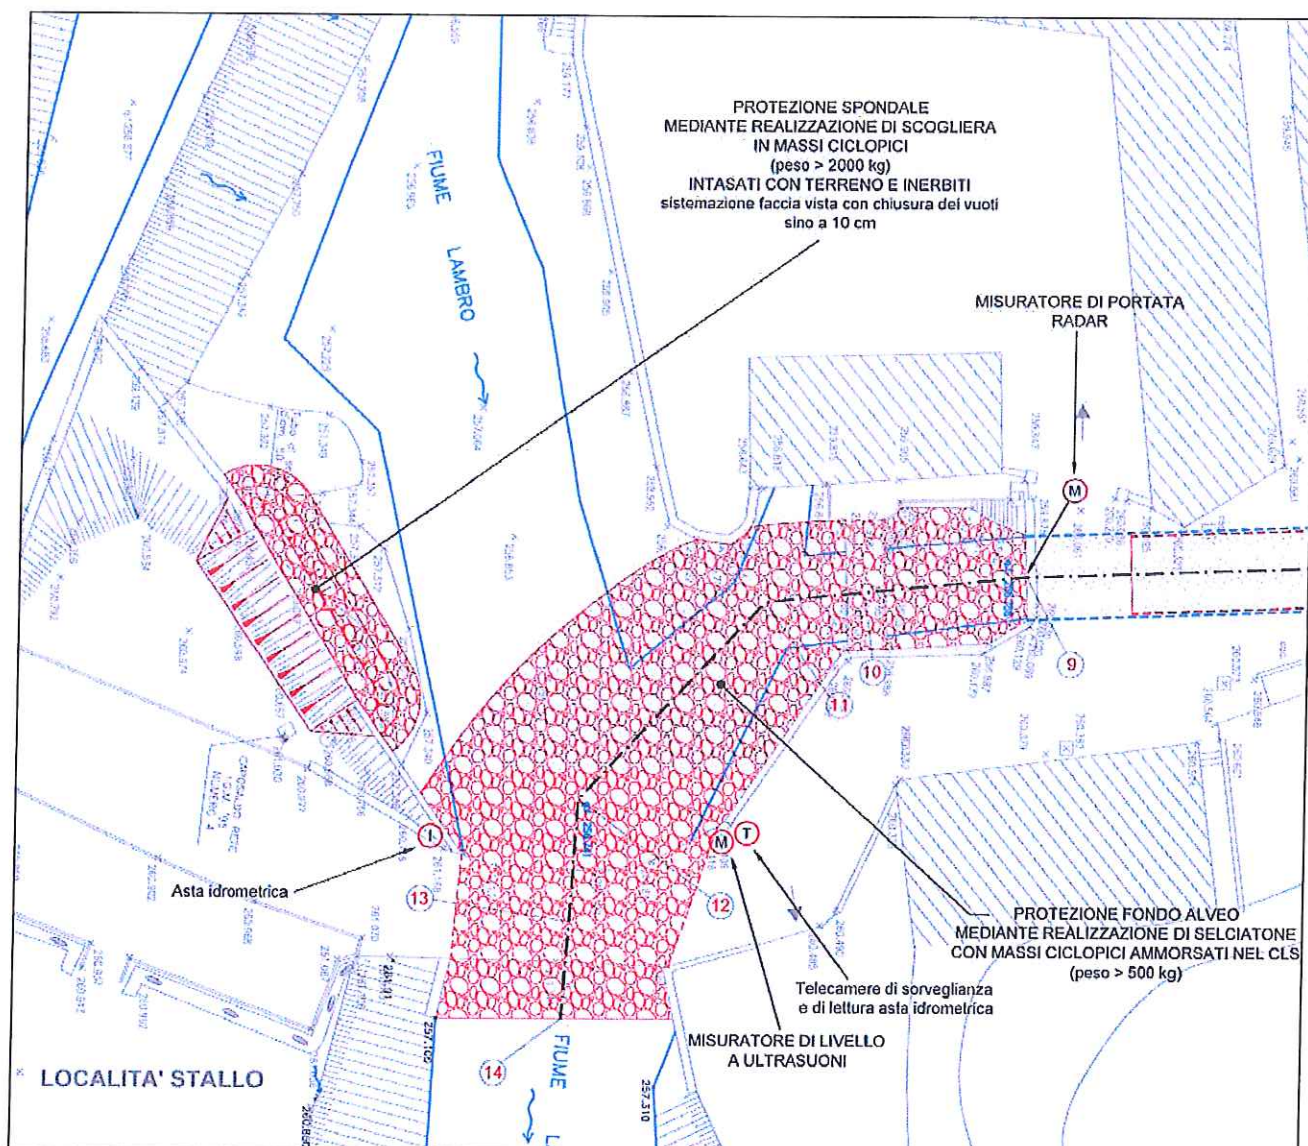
Interventi imbocco sud, dalla tavola "Planimetrie, sezioni e profilo longitudinale – Area d'intervento – Opere in progetto" redatta dai progettisti.
